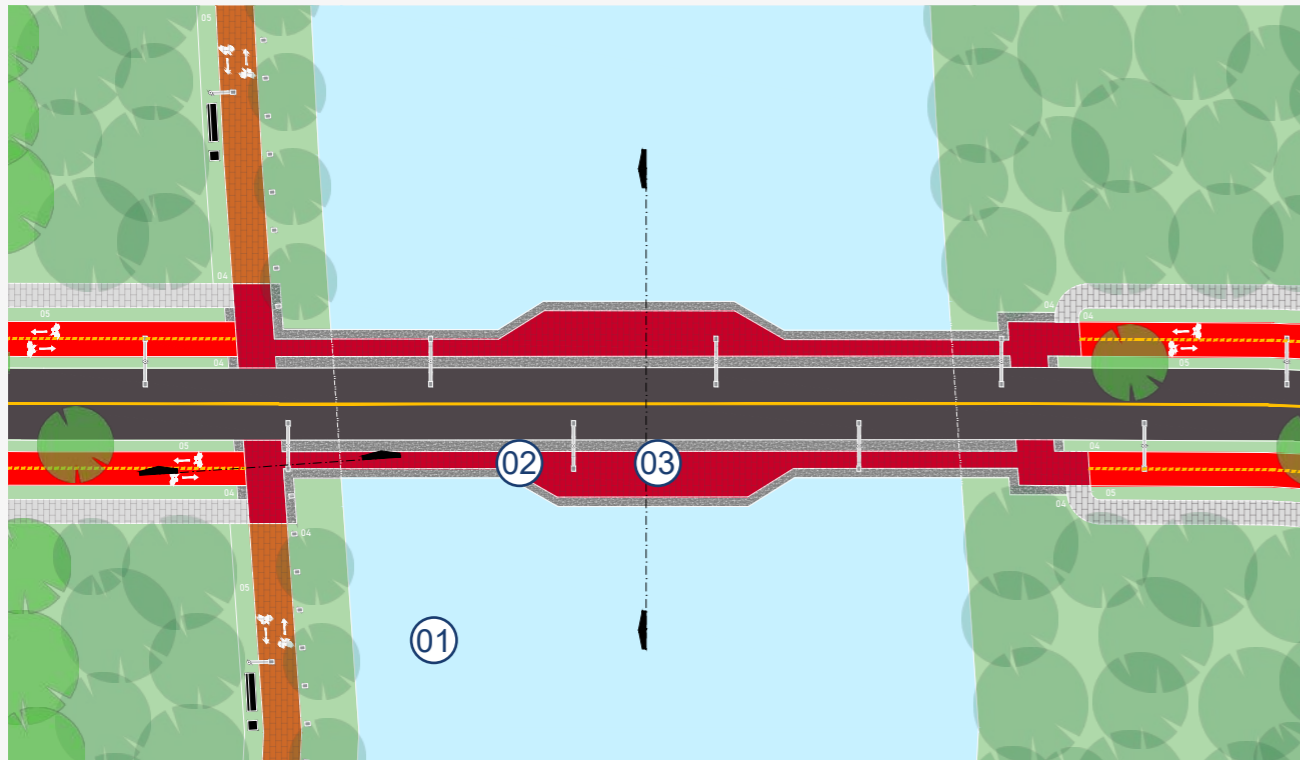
Vista em Perspectiva da Travessia do Rio Barão do Melgaço.
